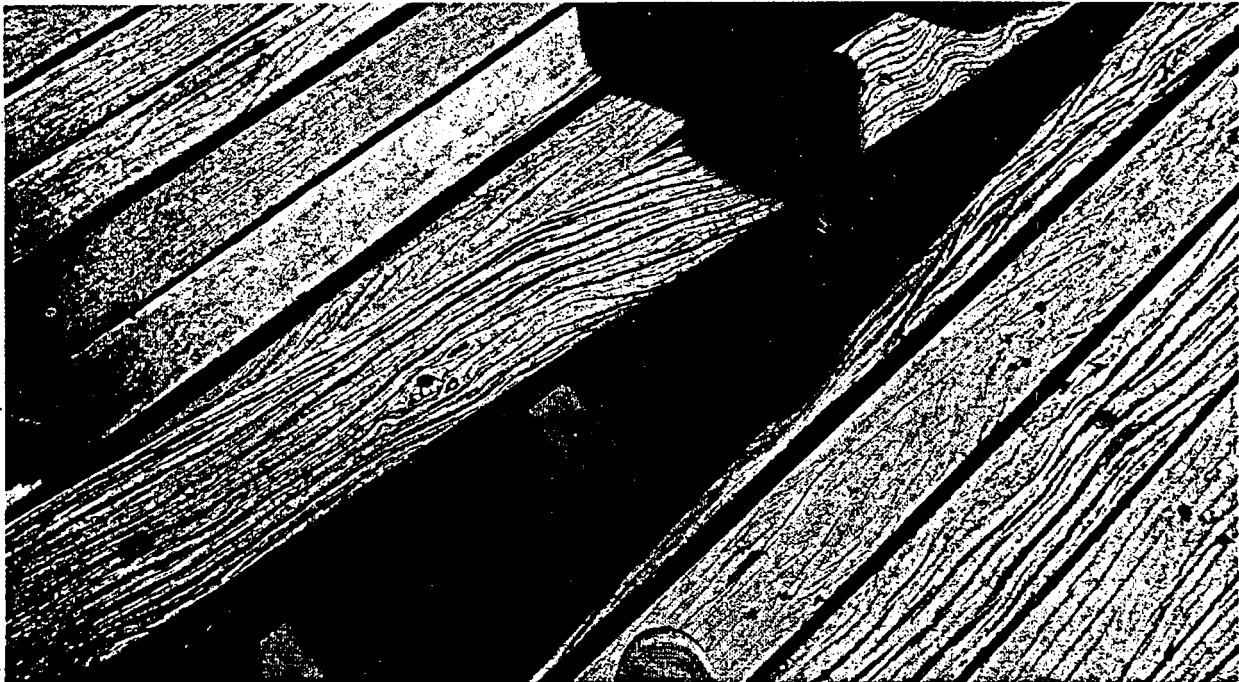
Vista das pranchas do piso a serem substituídas e das vigas de sustentação do piso.
